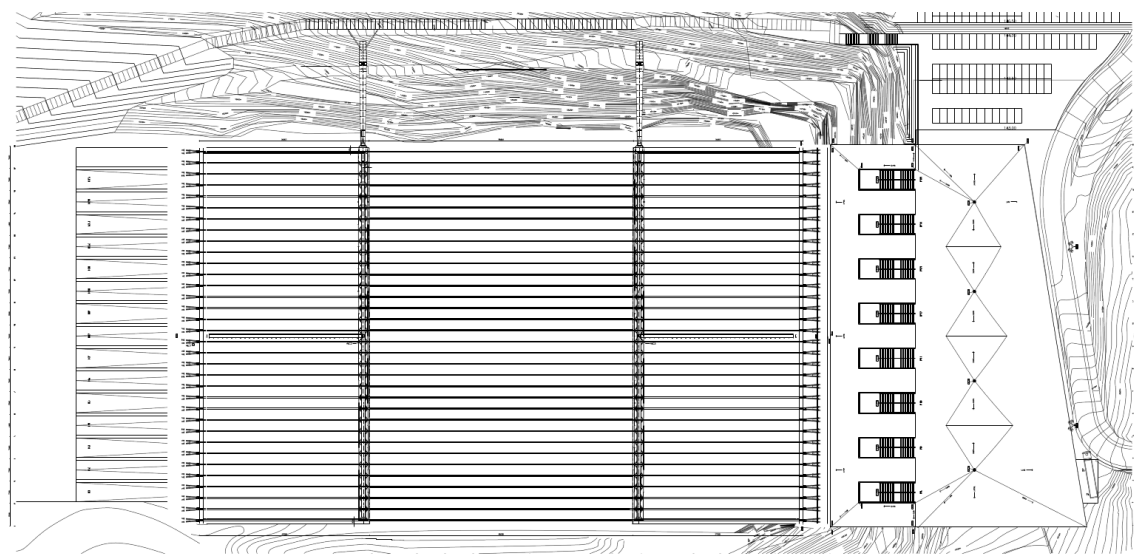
Planta geral, Eduardo Souto Moura, 2003
